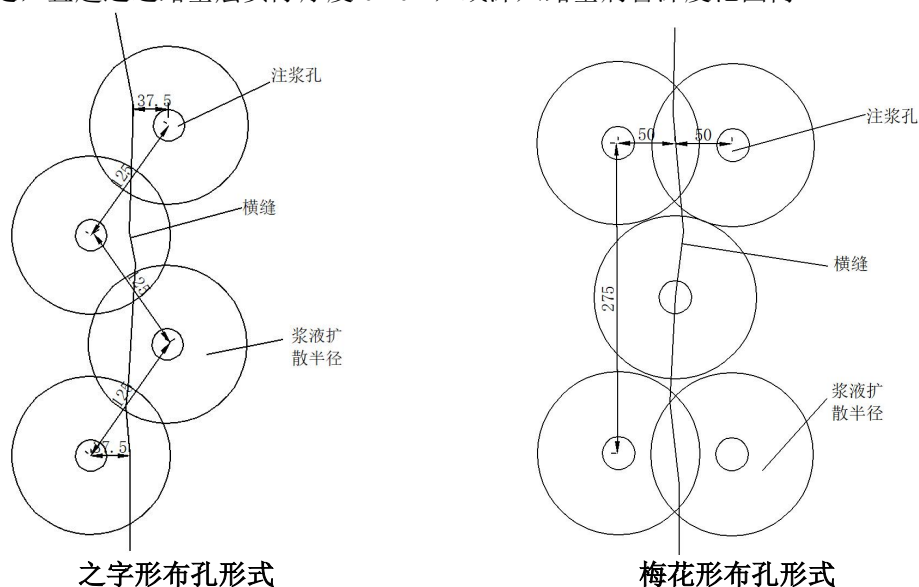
沥青混凝土路面注浆布孔形式
